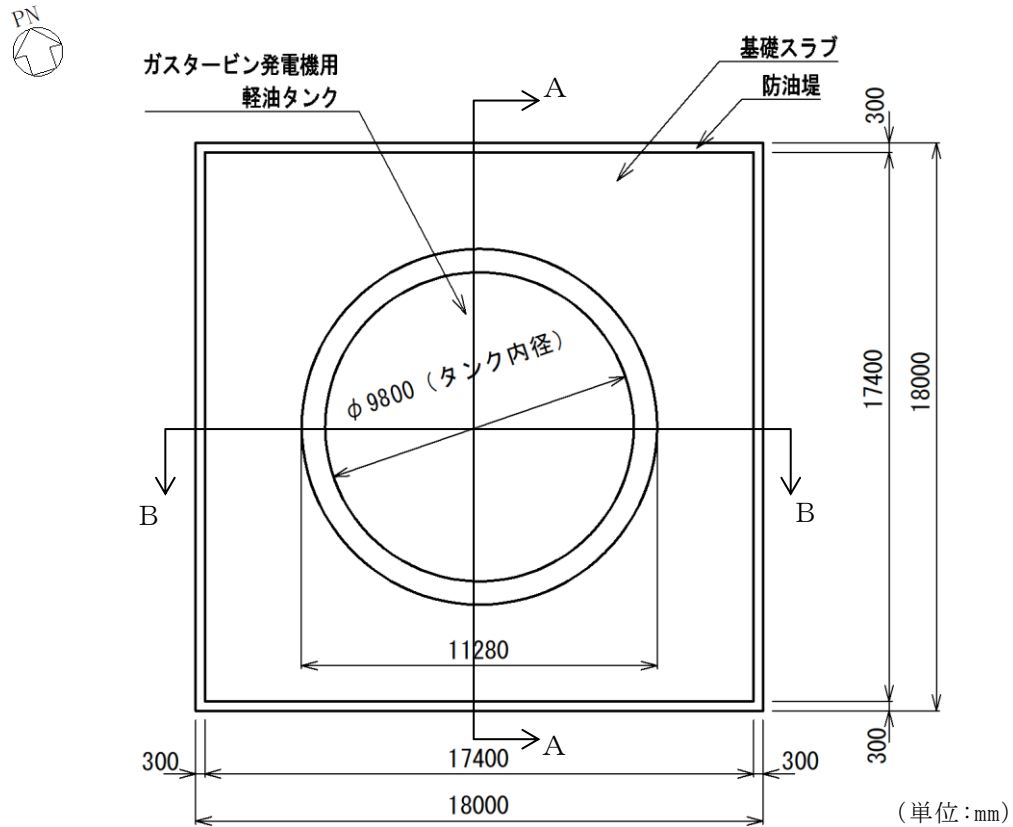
ガスタービン発電機用軽油タンク基礎 平面図
